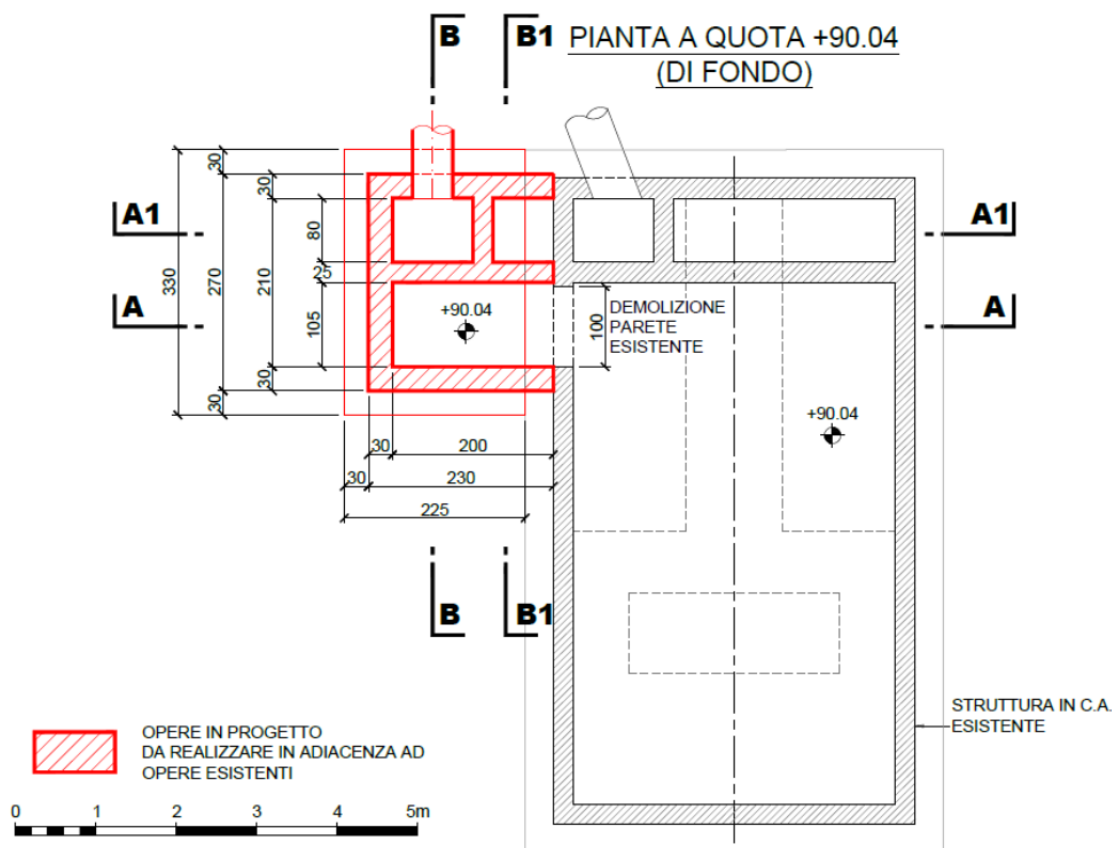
POZZETTO RIPARTITORE AL DECANTATORE FINALE- PIANTA
